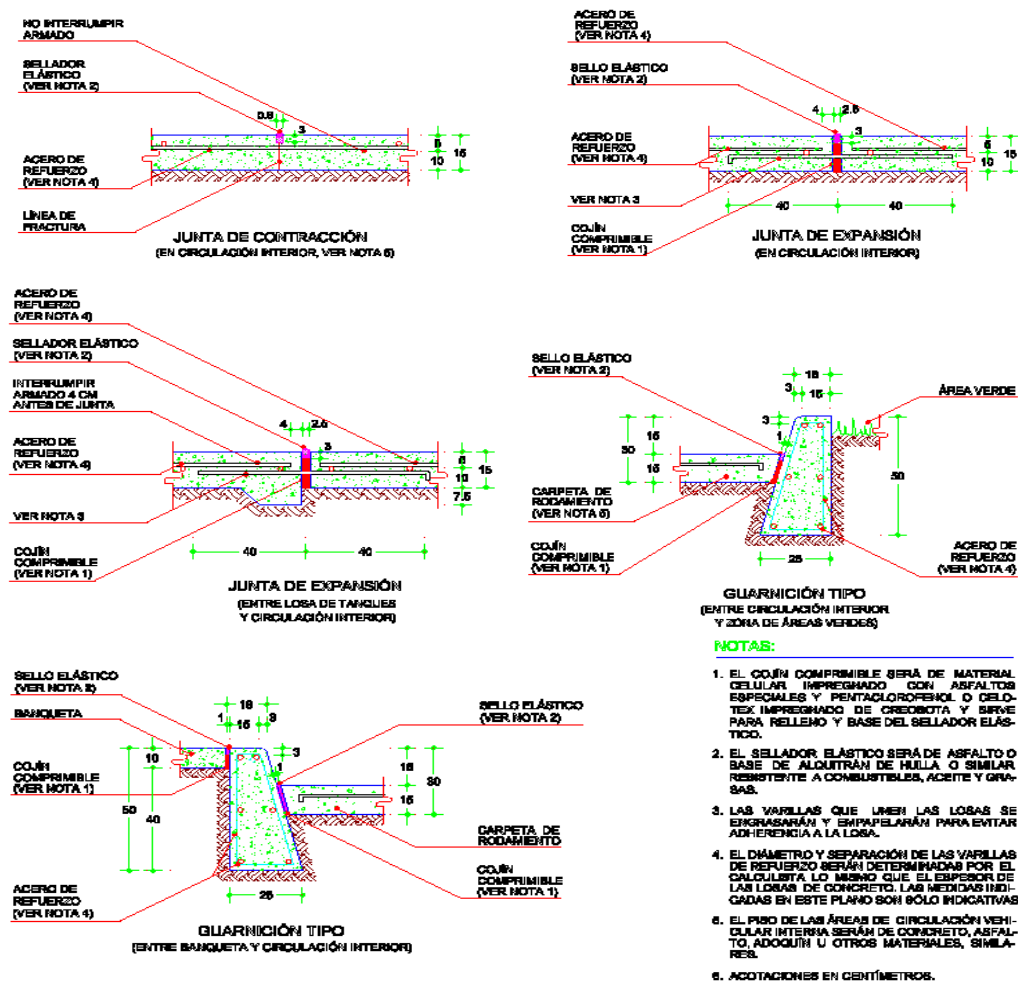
Juntas de contracción y expansión en zona de tanques y circulación terrestre.
